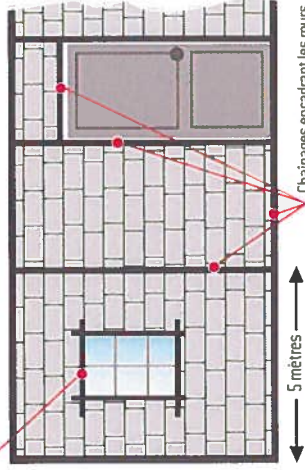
Ajout de chaînages horizontaux et verticaux encadrant les maçonneries (élévation)
